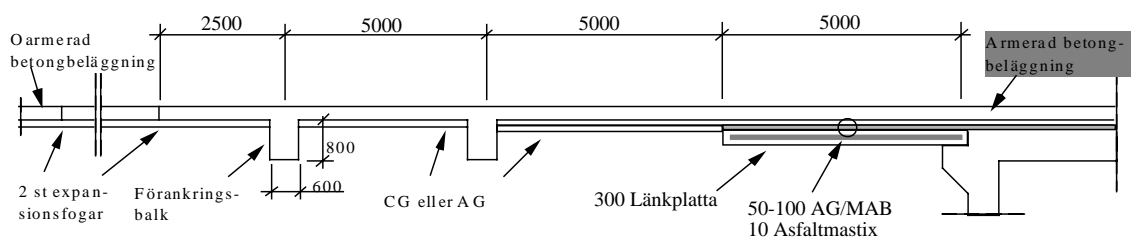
visar godtagbar utformning av anslutningskonstruktion mellan betongöverbyggnad och flexibel konstruktion.
